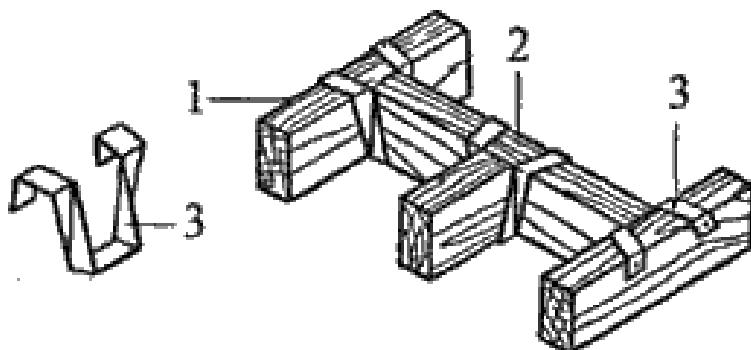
Установка ригелей: 1 — балка перекрытия; 2 — ригель; 3 — металлический хомут.
